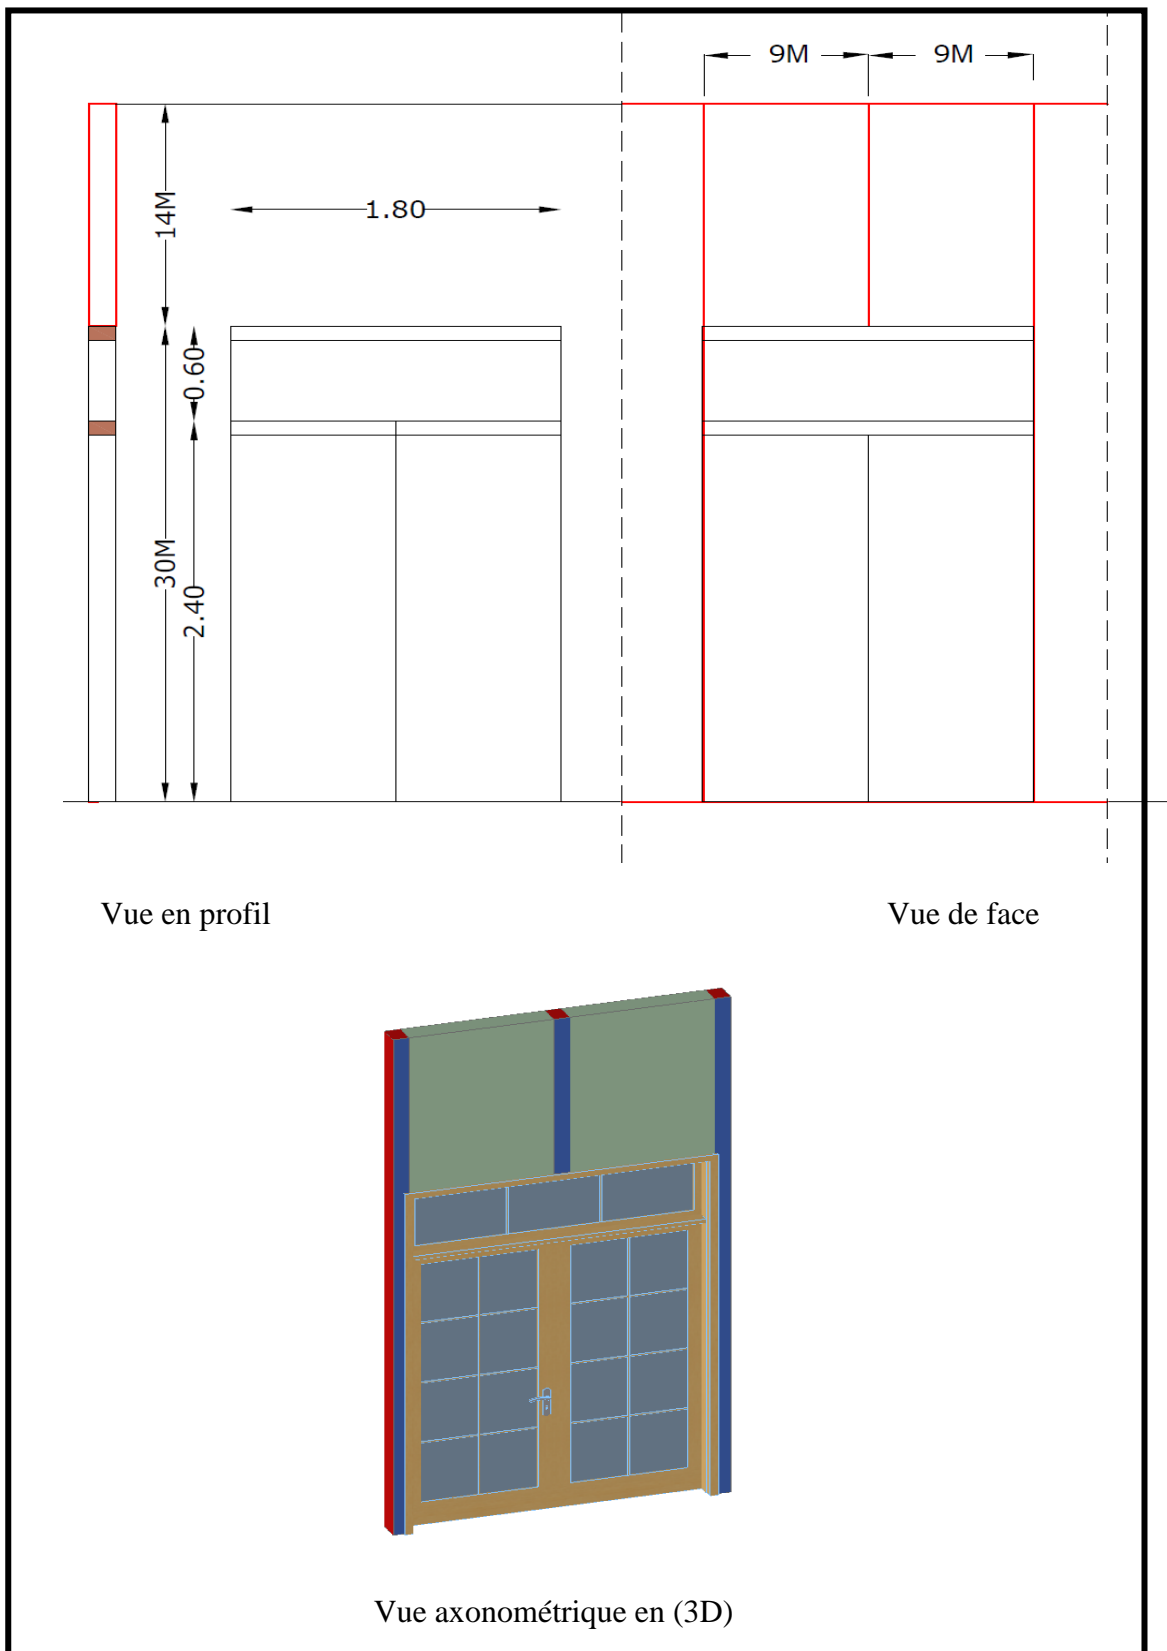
Panneau de façade baie cas d'une porte fenêtre
